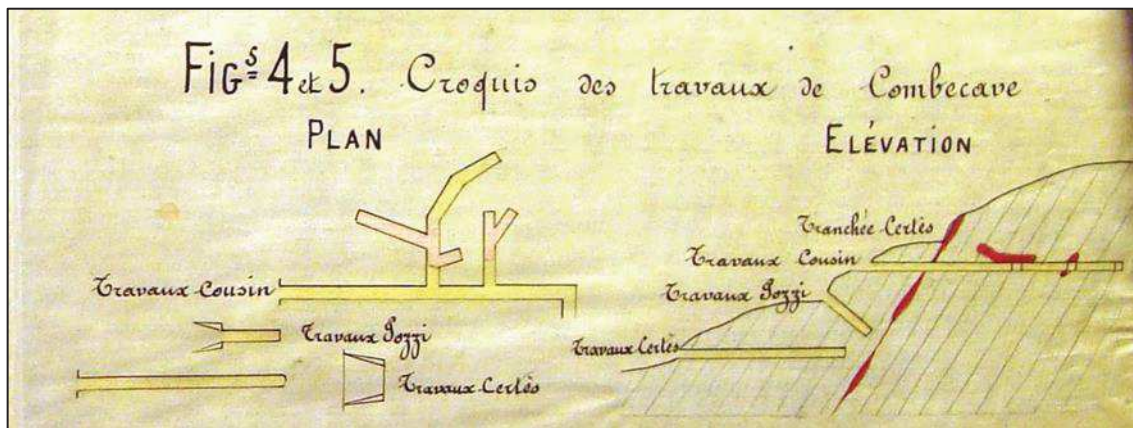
Secteur Combecave. Extrait de plan du 20 juillet 1884
